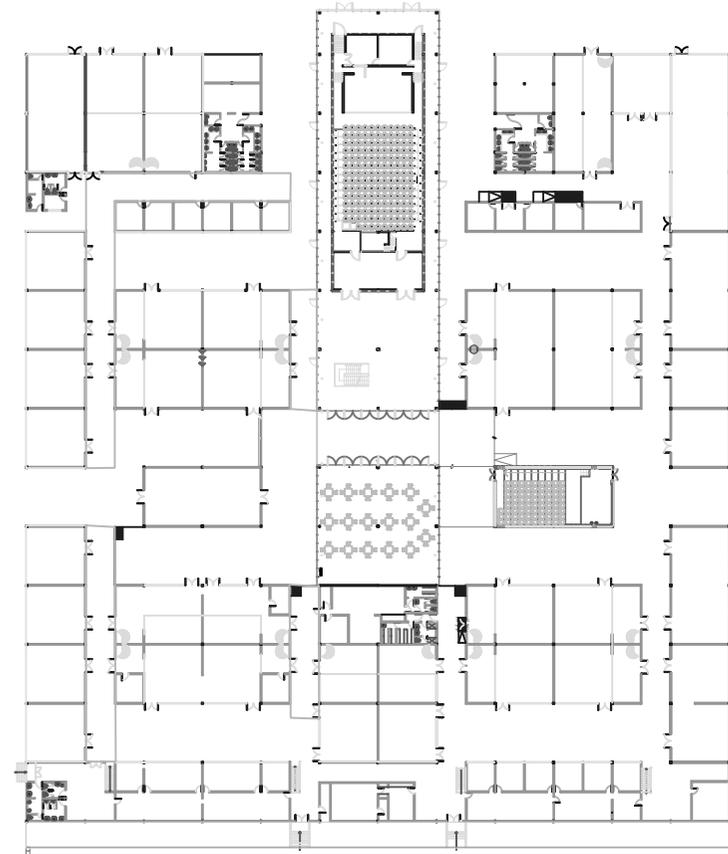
Planta arquitectónica actual Facultad de Artes con sede en Las Encinas, esc. 1:1000.
